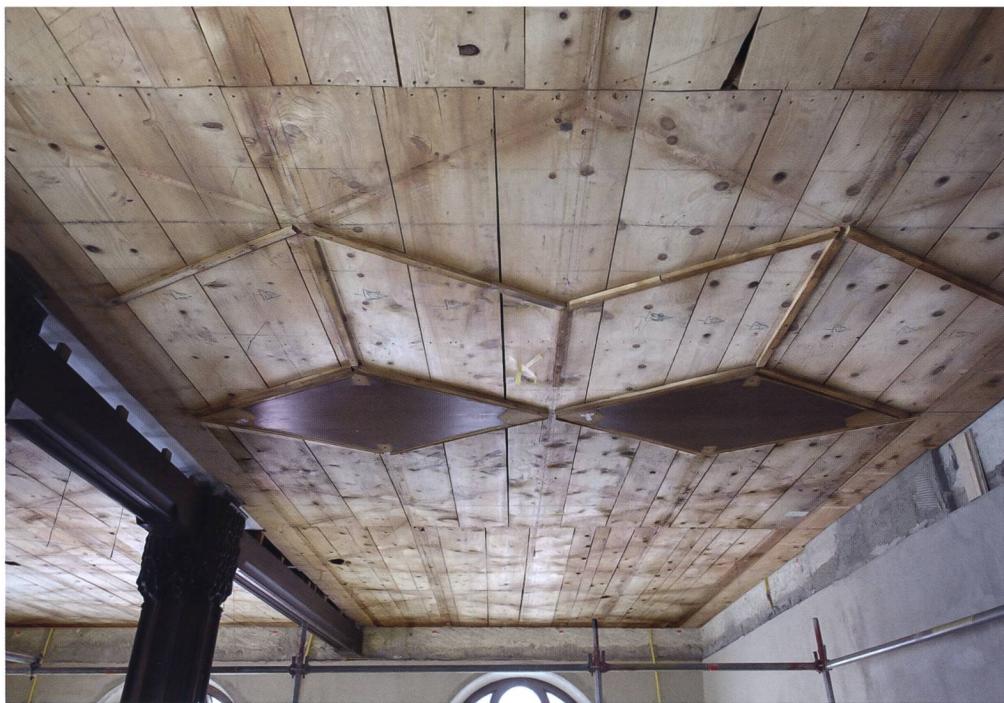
Durchgehende hölzerne Blinddecke mit Schiftplatten und zwei montierten Deckenfüllungen. Decke aus dem Schloss Arbon, Landesmuseum Zürich.
